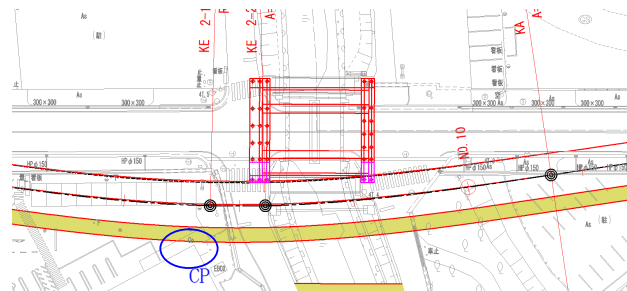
迂回路平面図(第2案：反復施工上流側迂回路案)
